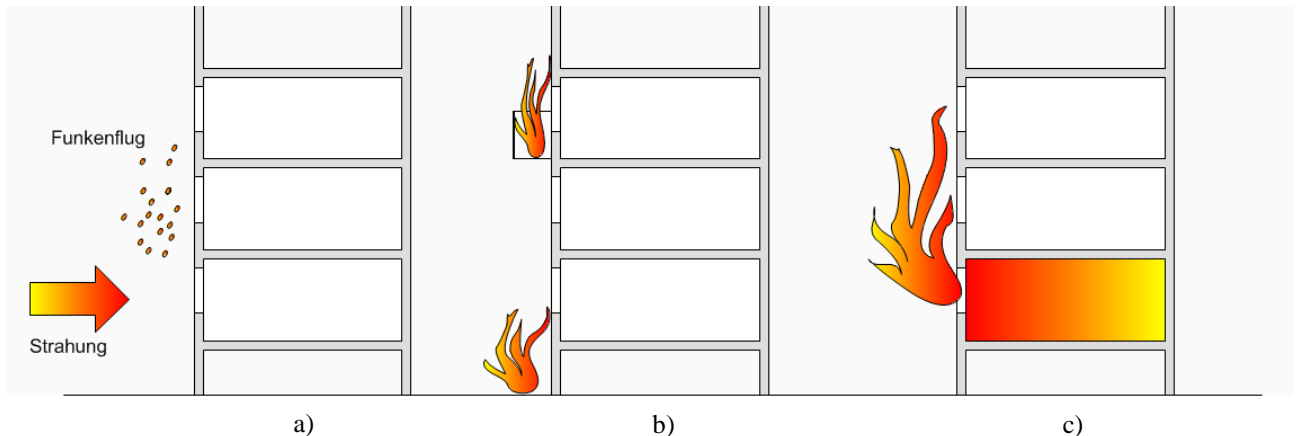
Brandszenarien a) Brand eines benachbarten Gebäudes b) Brand außerhalb des Gebäudes c) Brand innerhalb eines Gebäudes Fire scenarios a) Fire of a neighboring building b) Fire outside the building c) Fire inside a building
